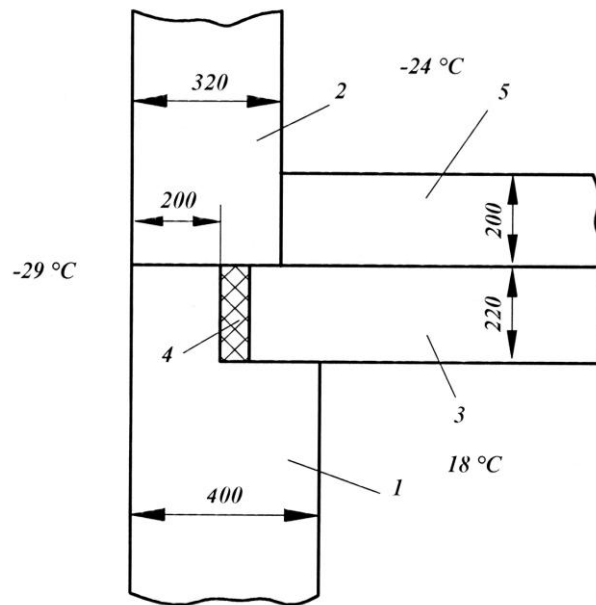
Схема карнизного вузла: 1 – стіна з керамзитобетонних блоків; 2 – фризний блок із шлакобетону; 3 – багатоповерхове горіщне перекриття; 4 – мінеральна вата; 5 – шлакова засипка
